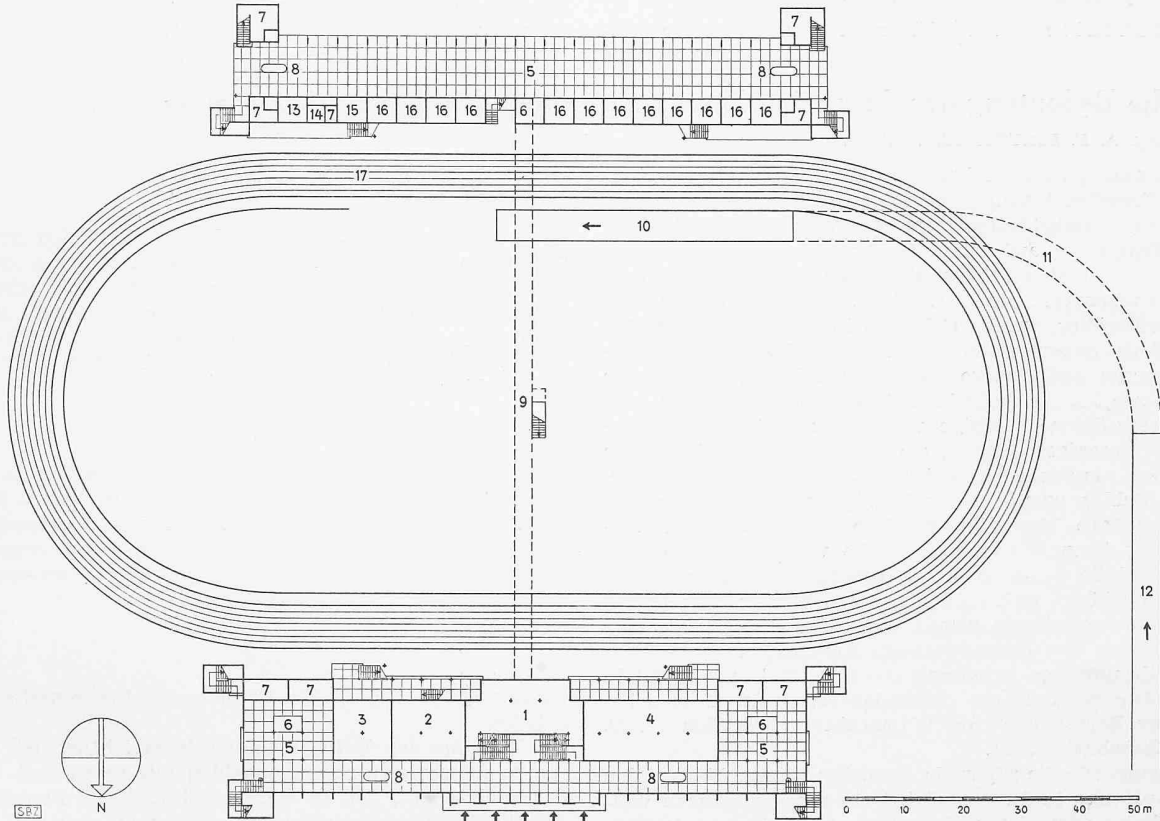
Radrennbahn in Caracas, Grundriss 1:1250
